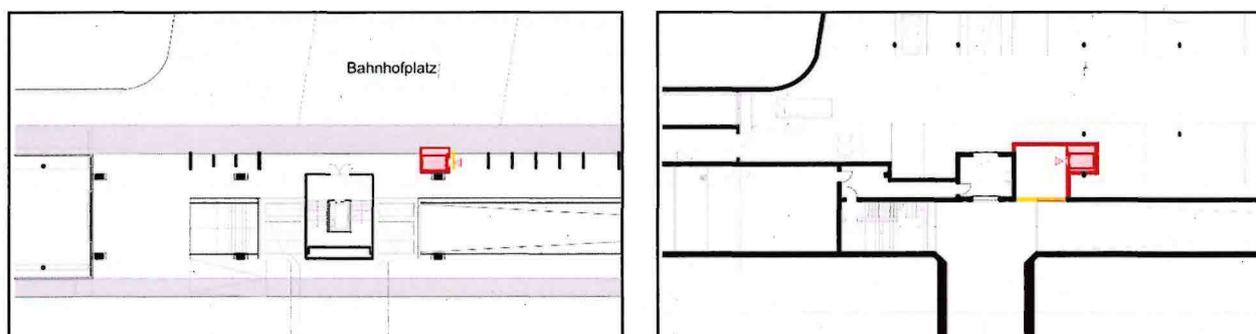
Grundrisse Lift Bahnhofplatz (links Ebene Bahnhofplatz, rechts Ebene Unterführung)
